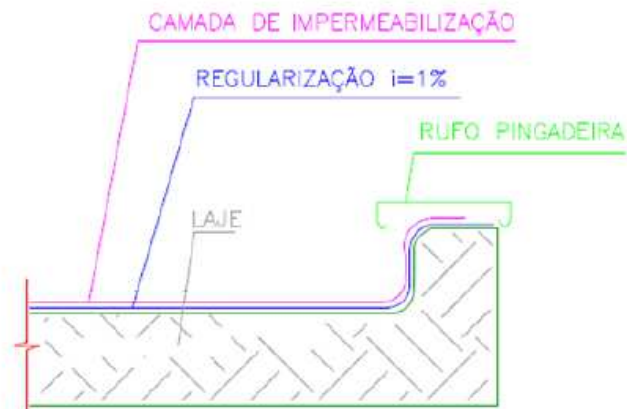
Detalhe da impermeabilização da laje de cobertura junto com as bordas laterais.
